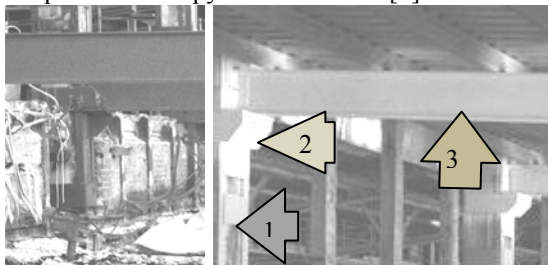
Узлы крепления балок пристройки к существующим железобетонным колоннам здания, где 1 - конструкции усиления; 2 - опорный элемент; 3 - балка пристройки
